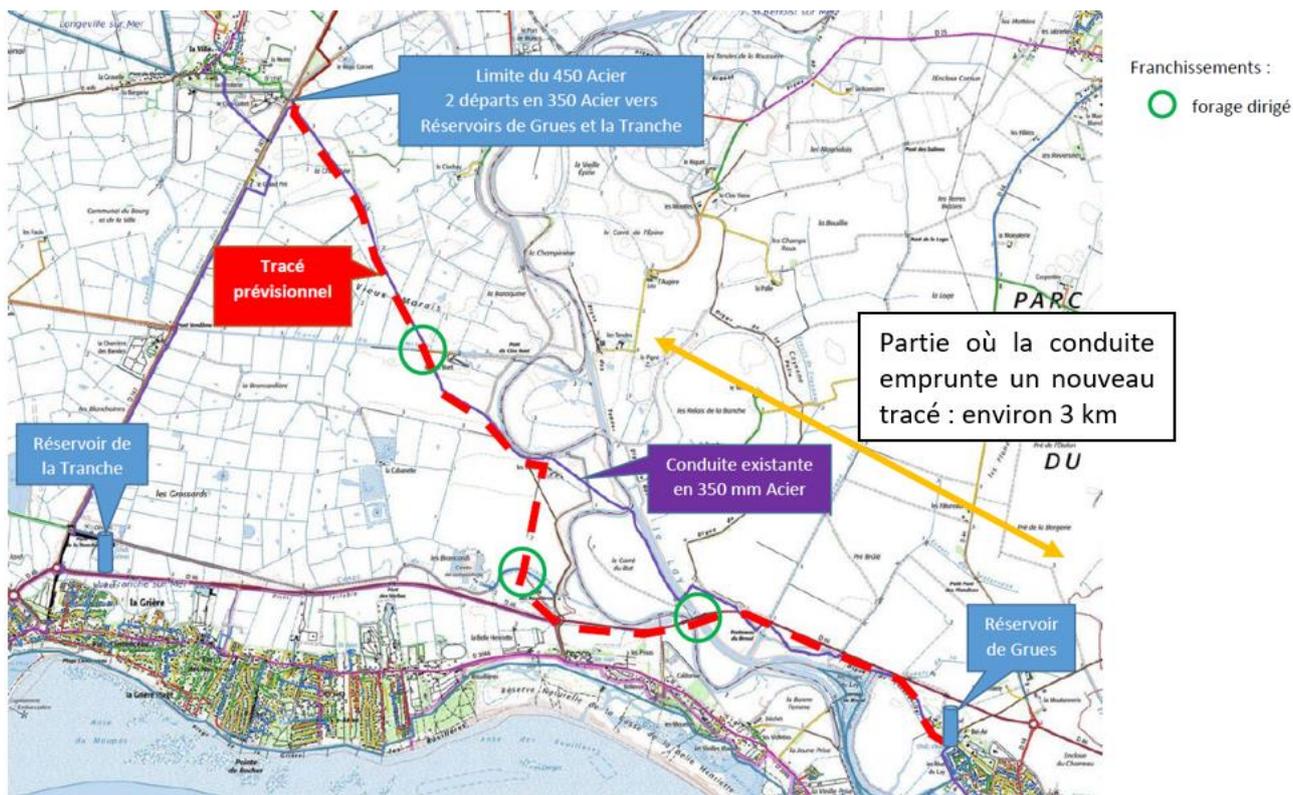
Conduite d'alimentation en eau potable d'Angles au réservoir de Grues : tracé existant (violet) et à renouveler (pointillé rouge)
